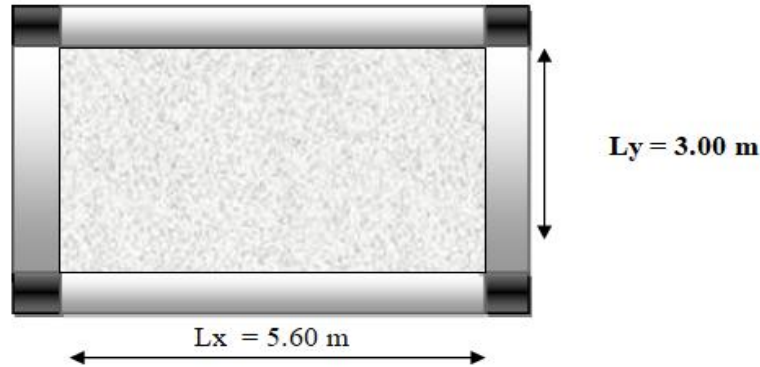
Dalle sur quatre appuis «cage d'escalier»
